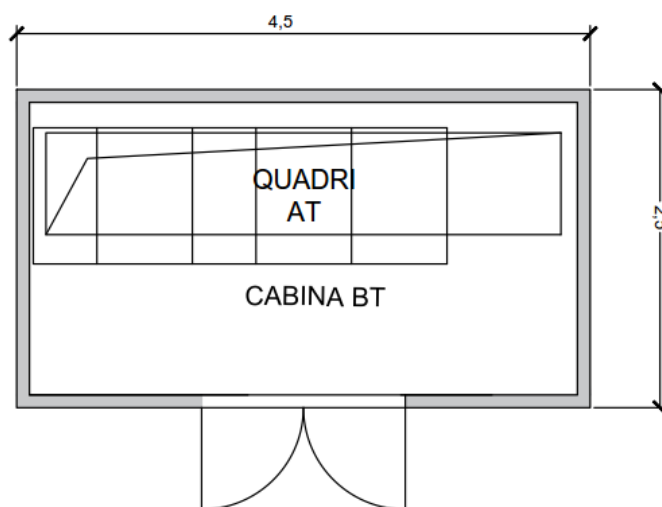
vista in pianta delle cabine di raccolta installate in campo
